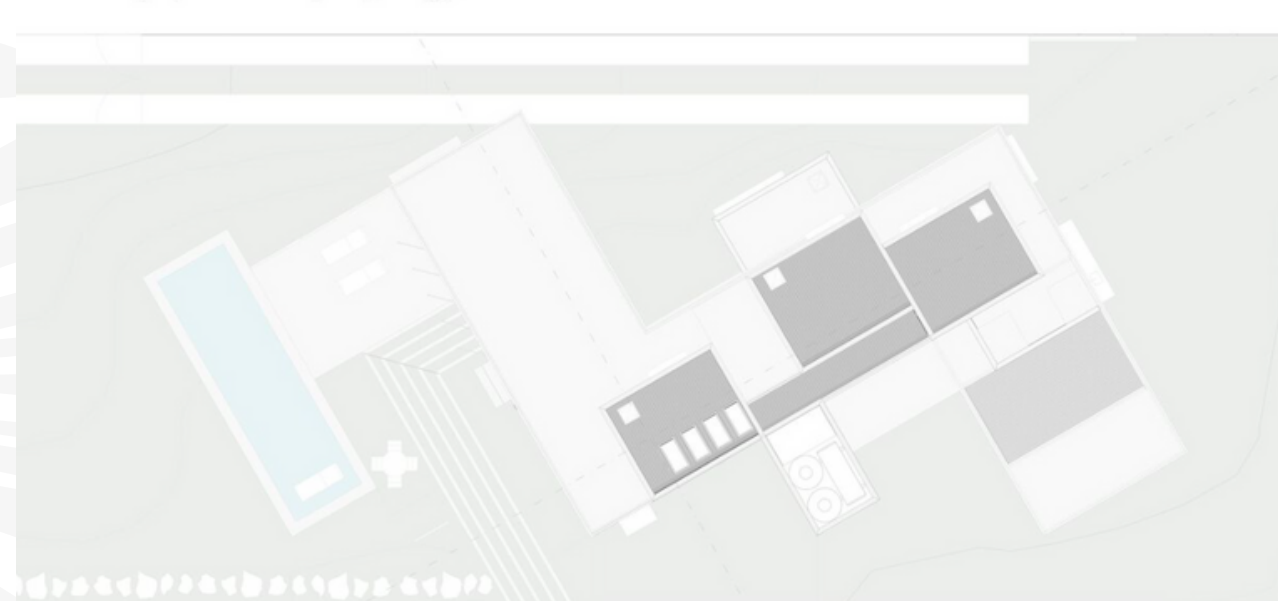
Projeto Casa Itatiba. Planta Cobertura. Fonte: Escritório 24-7 Arquitetura.
